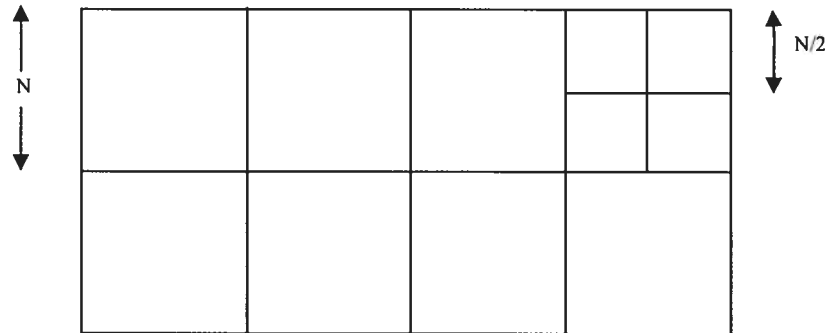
bloc en boutisse. Subdivision de la Pierre en  $N/2$
